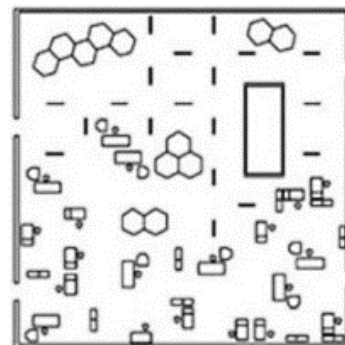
Planta Baixa - Térreo - Edifício *Larkin Administration Building
